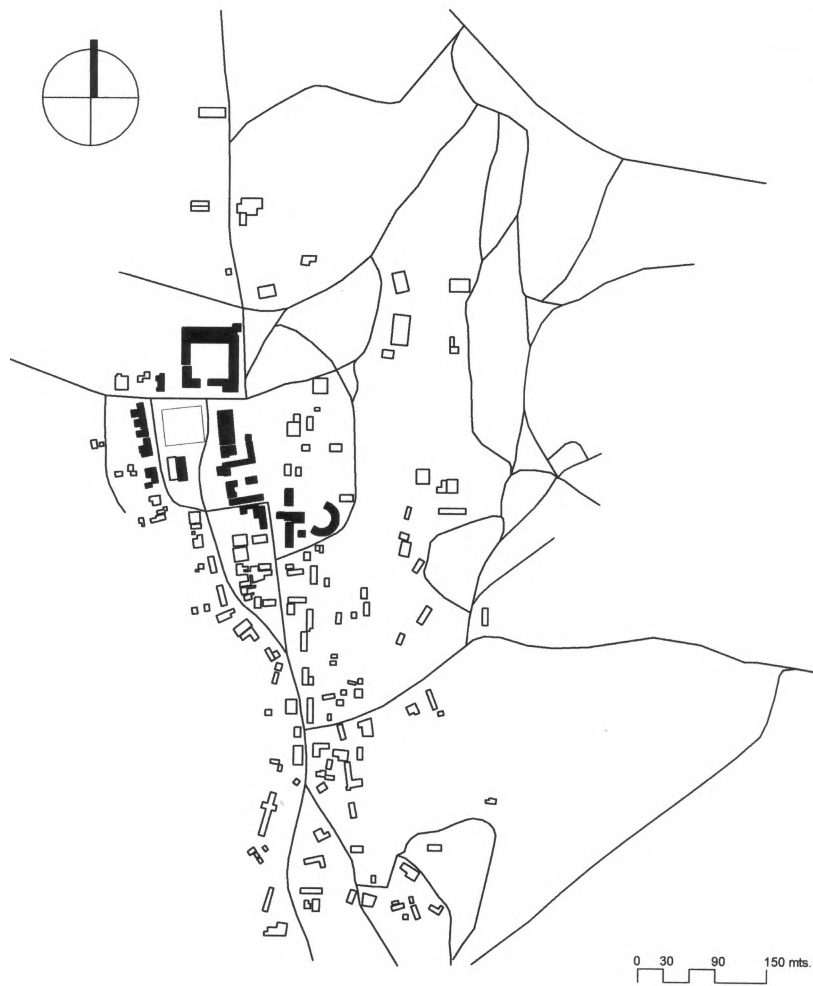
Planta de conjunto del área de un sitio de ganado mayor en donde se ubican las principales edificaciones de la hacienda de Bonanza. Se han sombreado con color negro las obras que presentan mampostería de piedra y tierra, y techos de tierra sobre vigas o morillos de madera; se aprecia del lado derecho el tren circular de hornos. No se han encontrado vestigios de las obras del método de beneficio por patio que menciona el inventario de 1810. Elaborado por el autor y Christian Enríquez, mediante prospección en sitio y con apoyo en fotografía aérea (2011)
